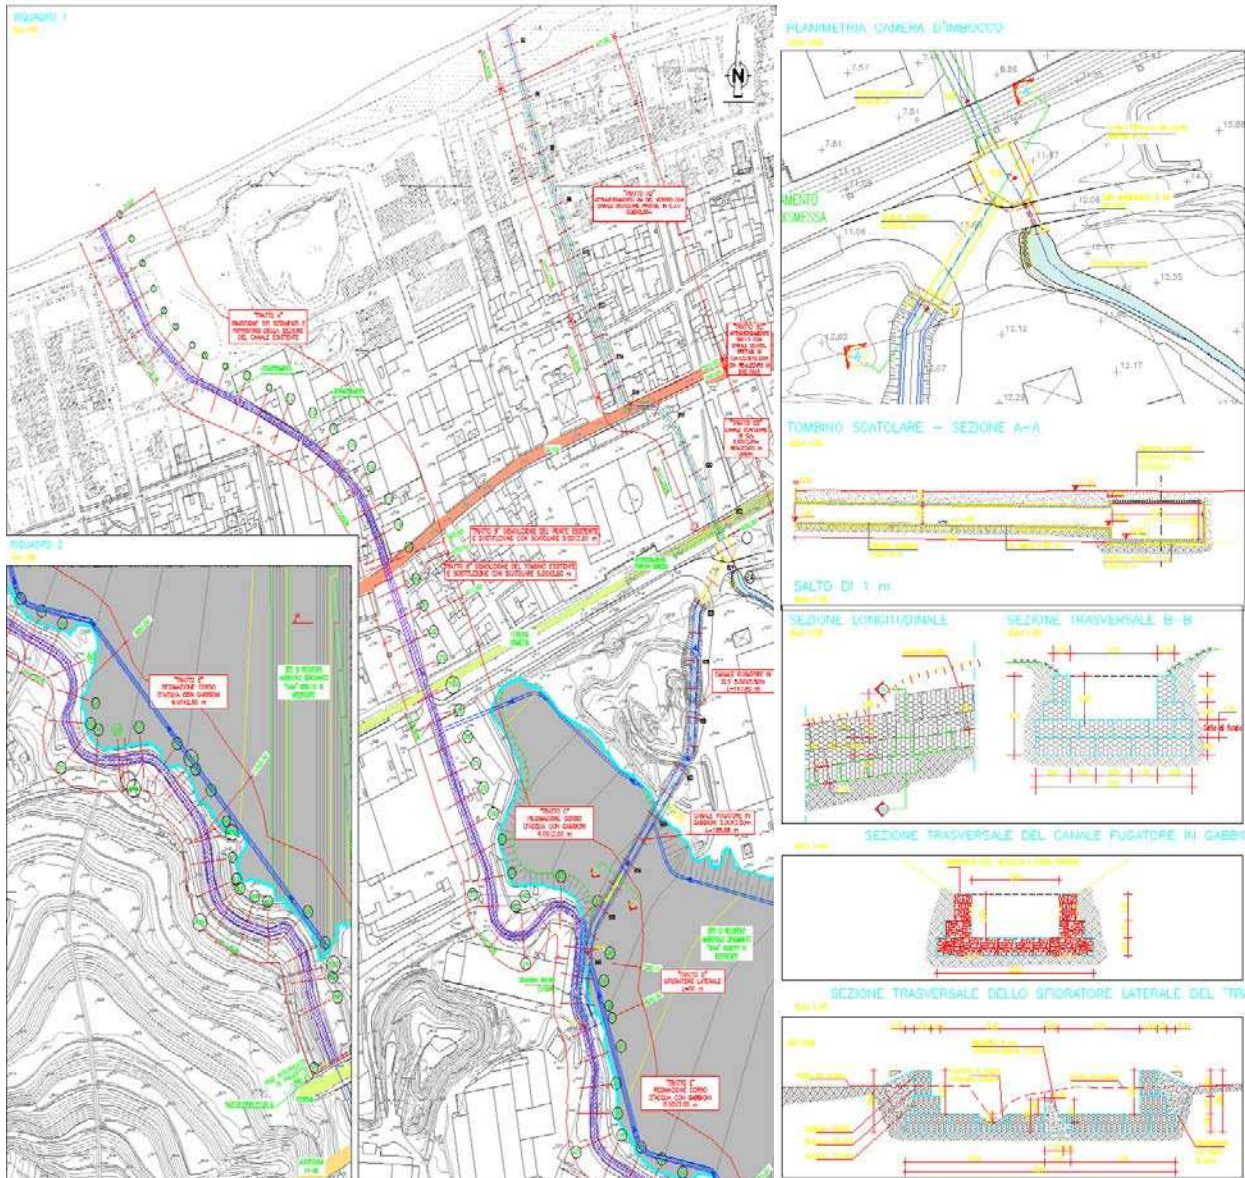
Planimetria del canale scolmatore, planimetria e sezione longitudinale della camera di imbocco, sezione trasversale del canale scolmatore e sezione trasversale dello sfioratore.
